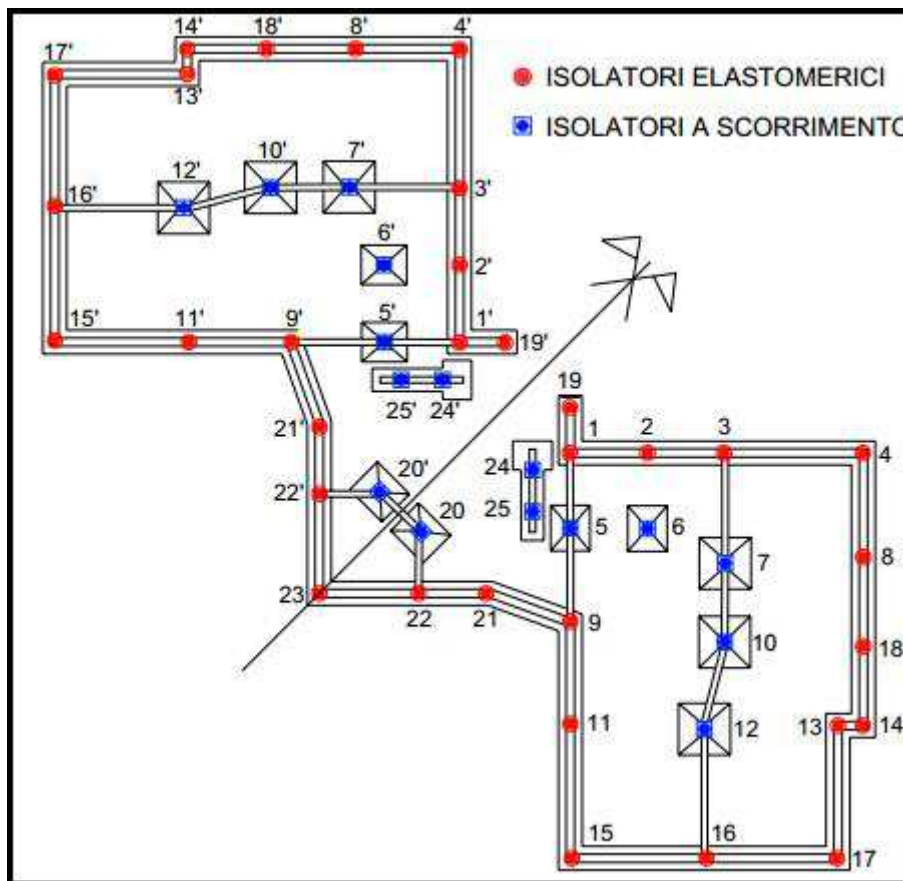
Pianta delle fondazioni e disposizione degli isolatori
